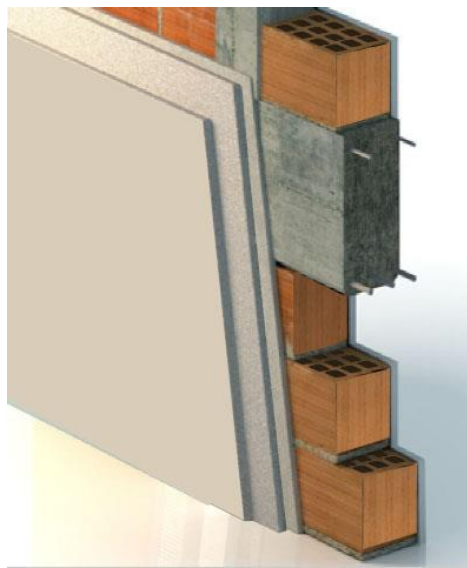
Corte perspectivado del sistema de muro utilizado
